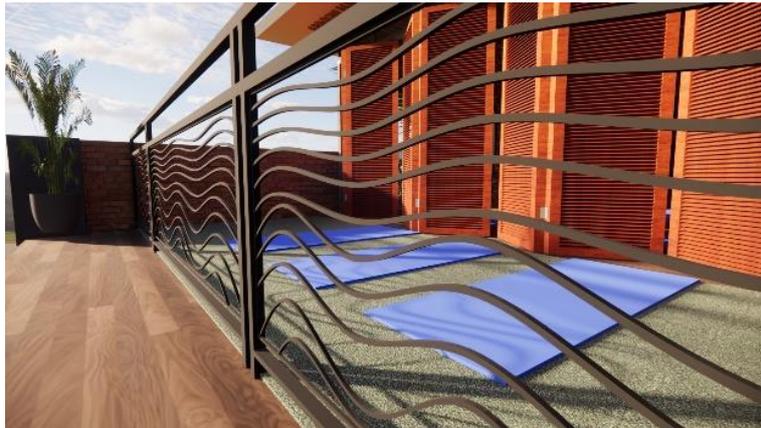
Signage* Lantai 3 Dan Ruang Interior Lantai 3
